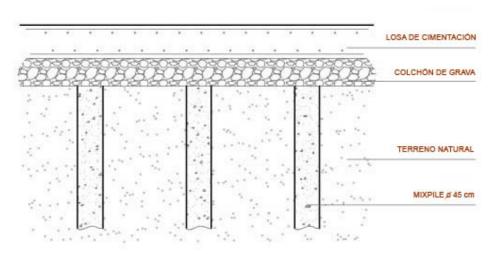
Losa de cimentación apoyada en pilotes Mixpile®
